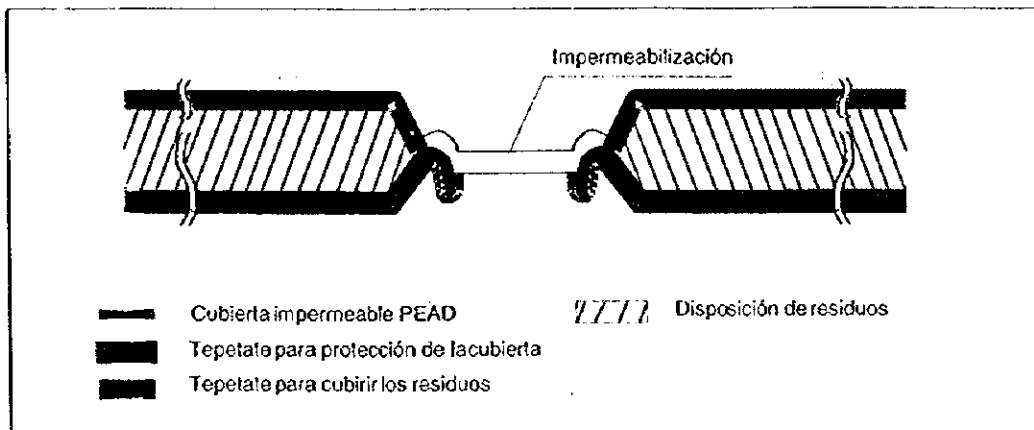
Impermeabilización de los Caminos del Primer Nivel
